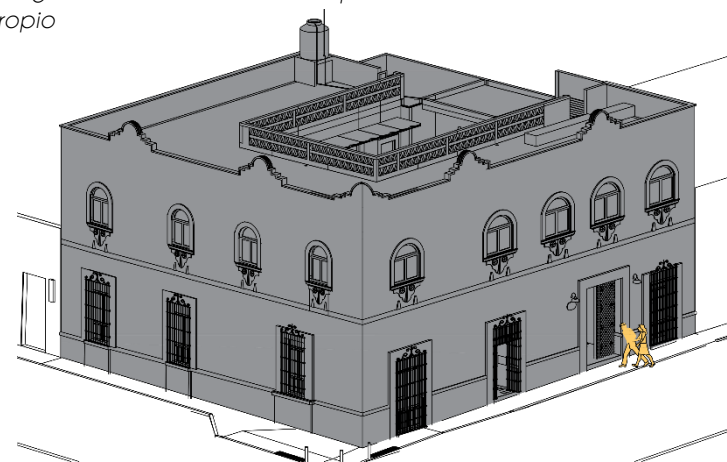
Modelo ilustrativo de los elementos en fachadas Fuente:
